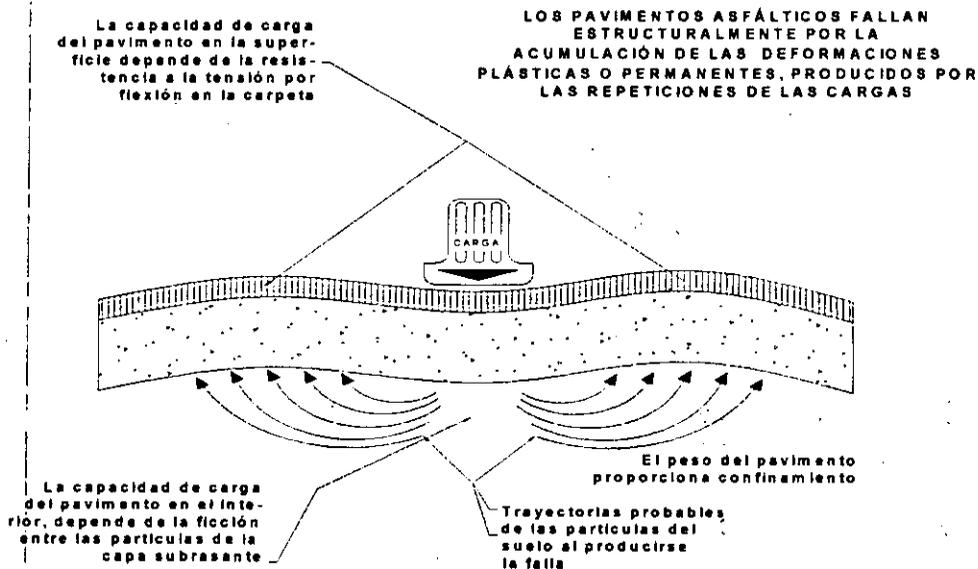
FALLA ESTRUCTURAL POR FALTA DE SOPORTE DE LA SUBBASE
